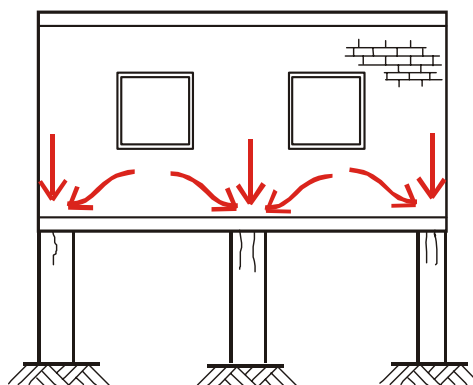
fissuras verticais por sobrecargas em pilares de alvenaria (DUARTE, 1998)
